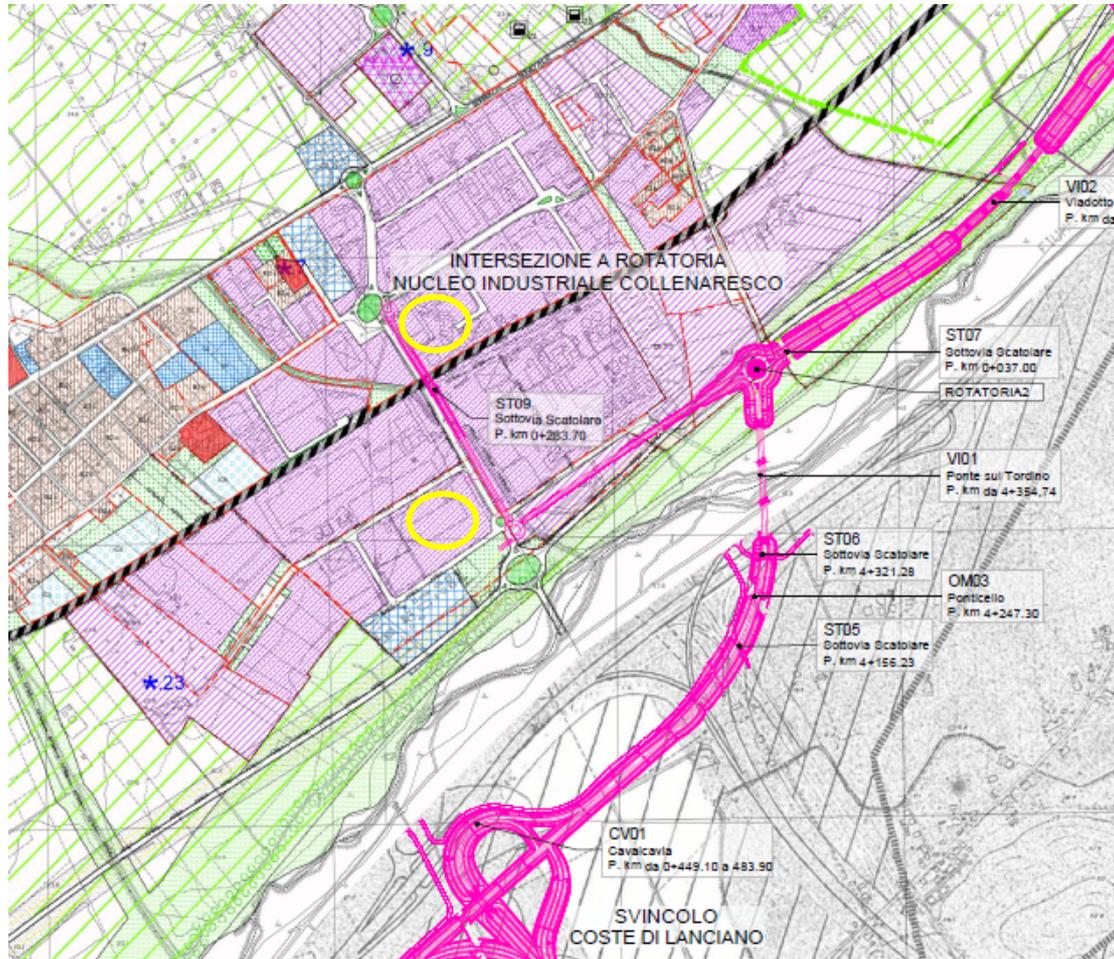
Stralcio PRG Comune di Roseto degli Abruzzi con individuazione Area Cantiere Base (CL01)
